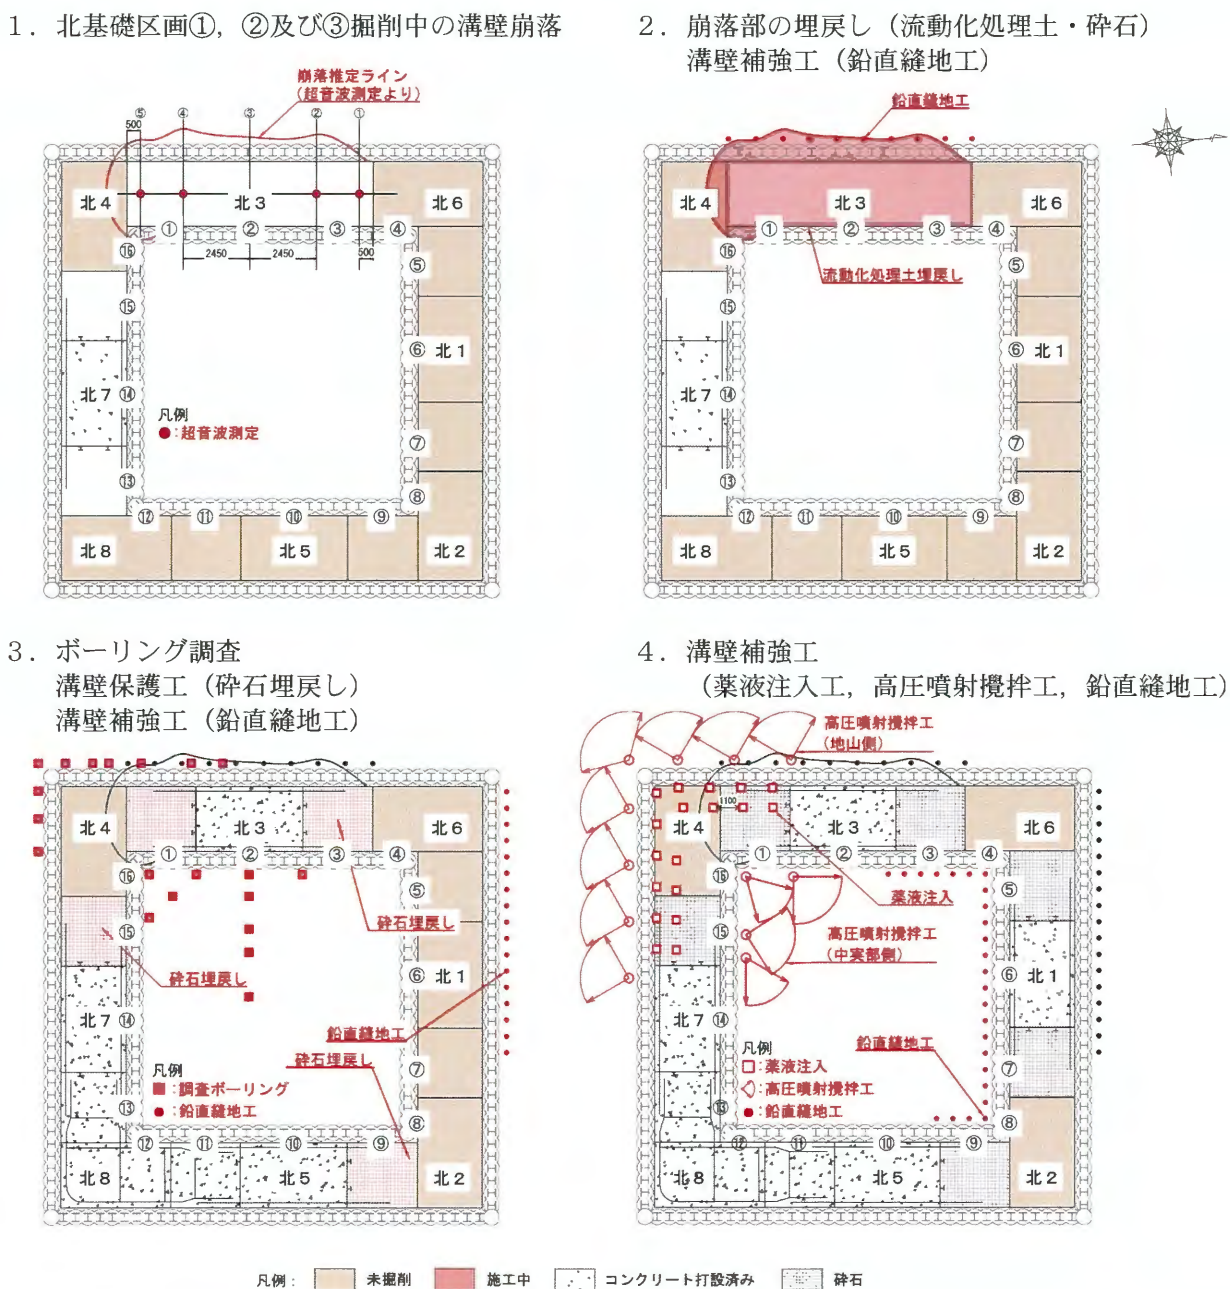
北基礎の施工履歴 (通常の施工状況と異なる事象など)
